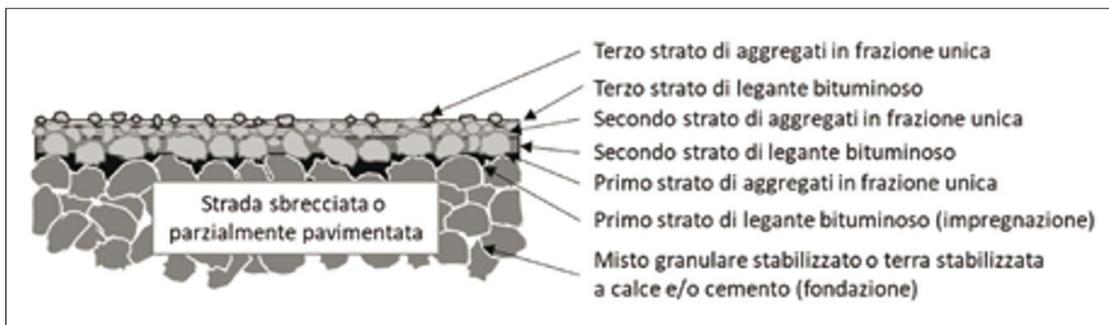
Schema tipico di un intervento di depolverizzazione a tre strati
